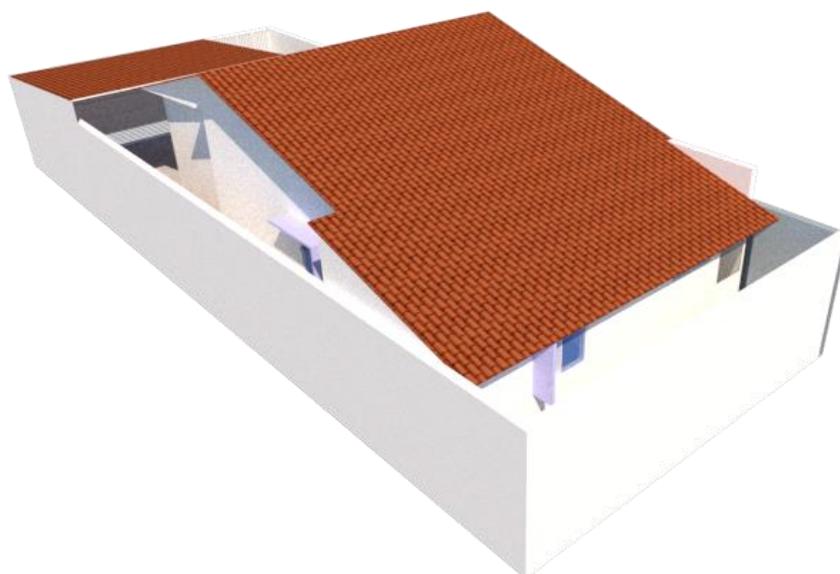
Proposta orientada à Nordeste - Fachada posterior
